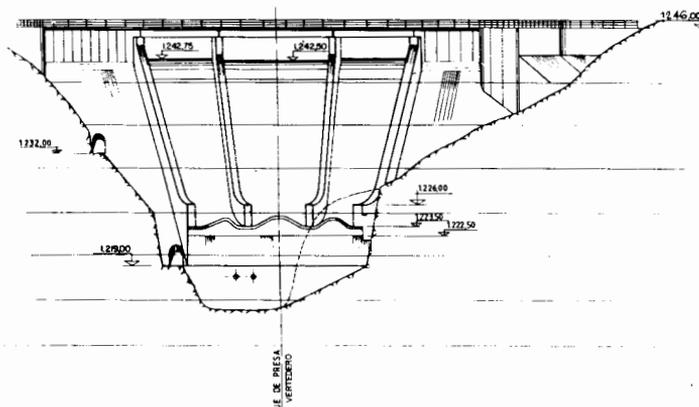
(c) Alzado desde aguas abajo.
